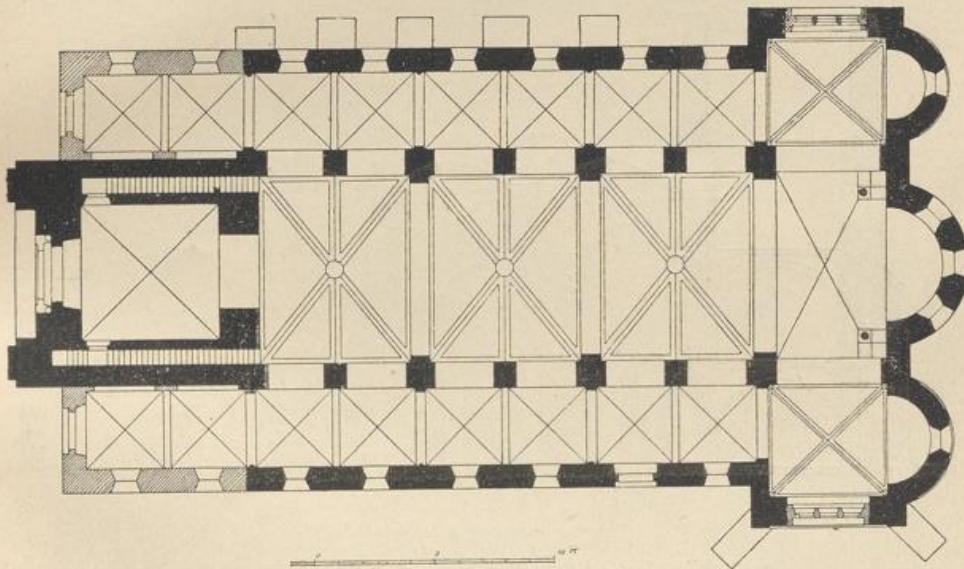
Wipperfürth. Grundriss der katholischen Pfarrkirche.
